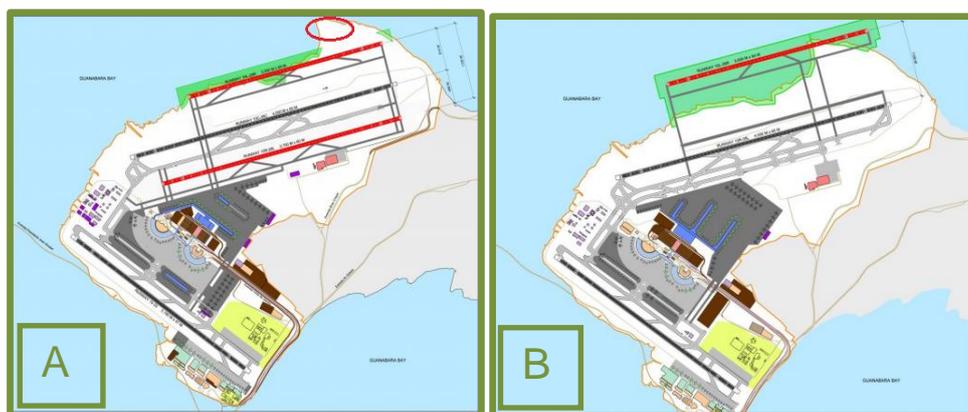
A) Projeto 2B: construção de duas pistas paralelas à pista 10R-28L existente. Tubiacanga ficaria “confinada” ao norte (círculo em vermelho); B) Projeto 3B: construção de uma pista somente, mas independente à pista 10R-28L. A nova pista seria construída sobre a comunidade. Fonte: RELATÓRIO 3: IMPACTOS AMBIENTAIS, 2013.
